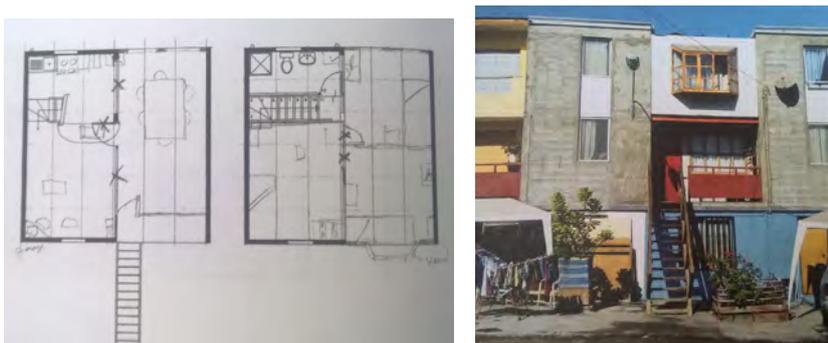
e 120: Planta baixa e implantação do caso 2. FONTE: livro ELEMENTAL
